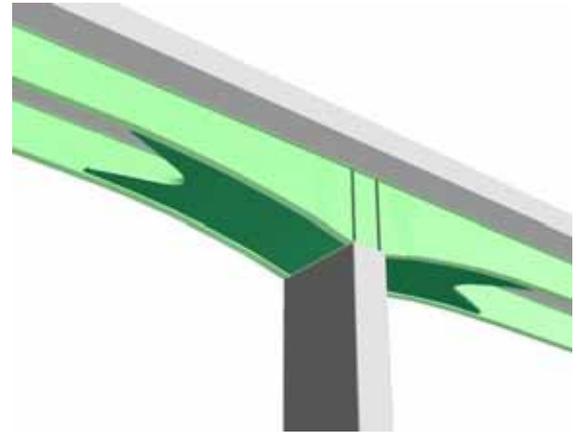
鋼・コンクリート二重合成 I 桁橋の概要
